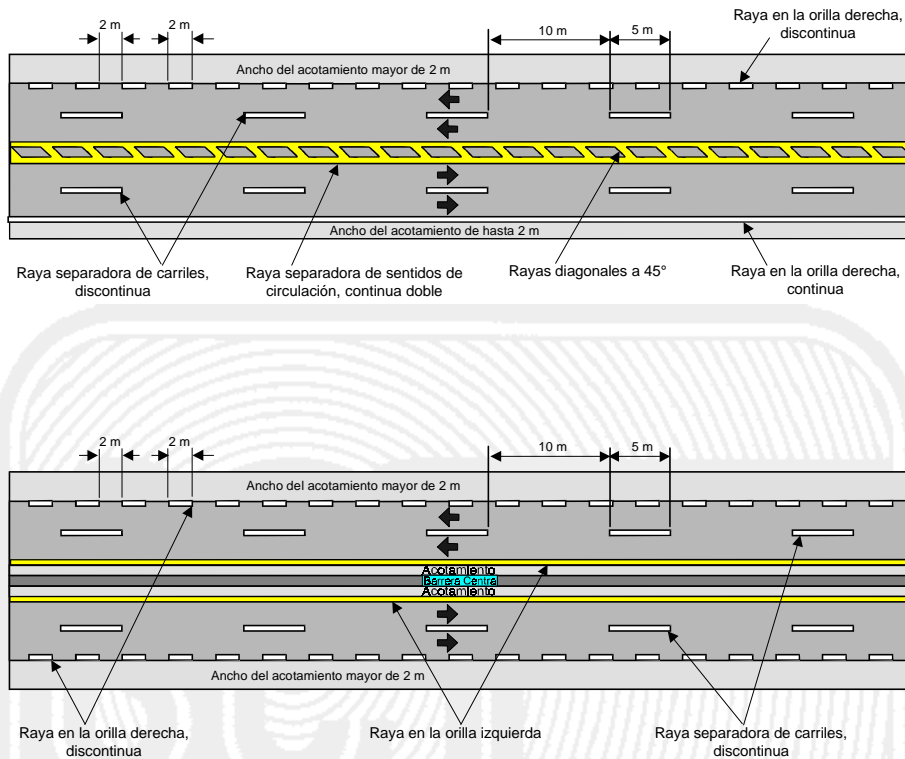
Marcas en el pavimento en autopistas y carreteras de cuatro o más carriles
